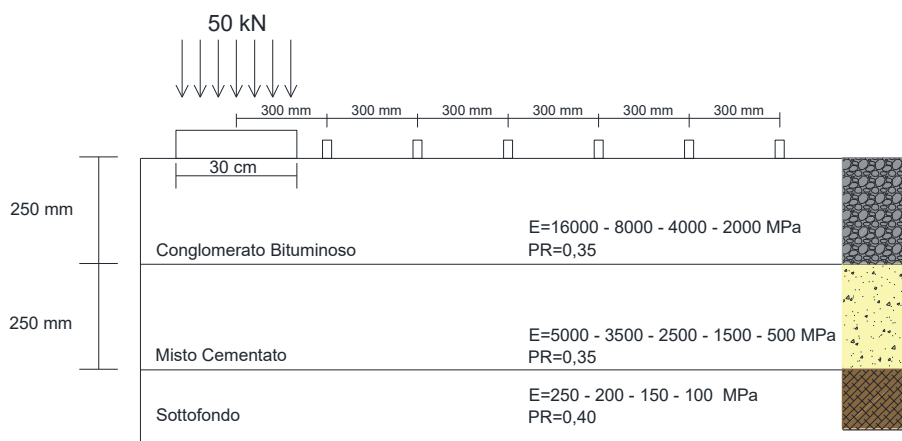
Stratigrafia pavimentazione autostradale con usura chiusa
